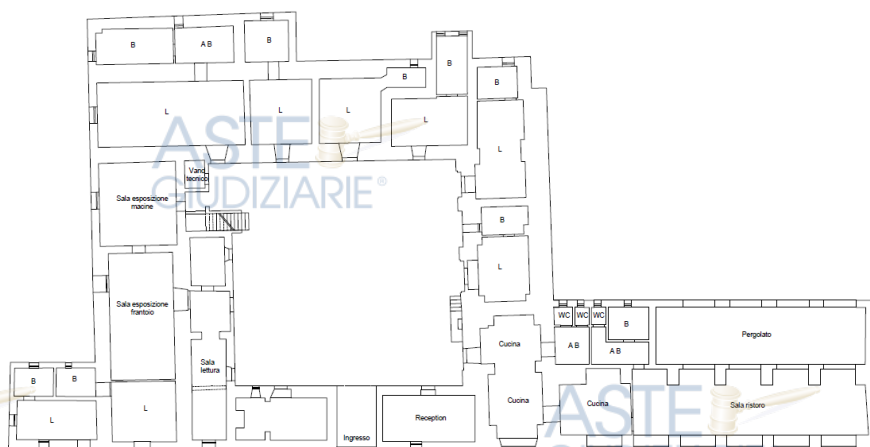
Planimetria rilevata del piano terra della masseria con indicazione delle destinazioni d'uso di progetto (non in scala)
